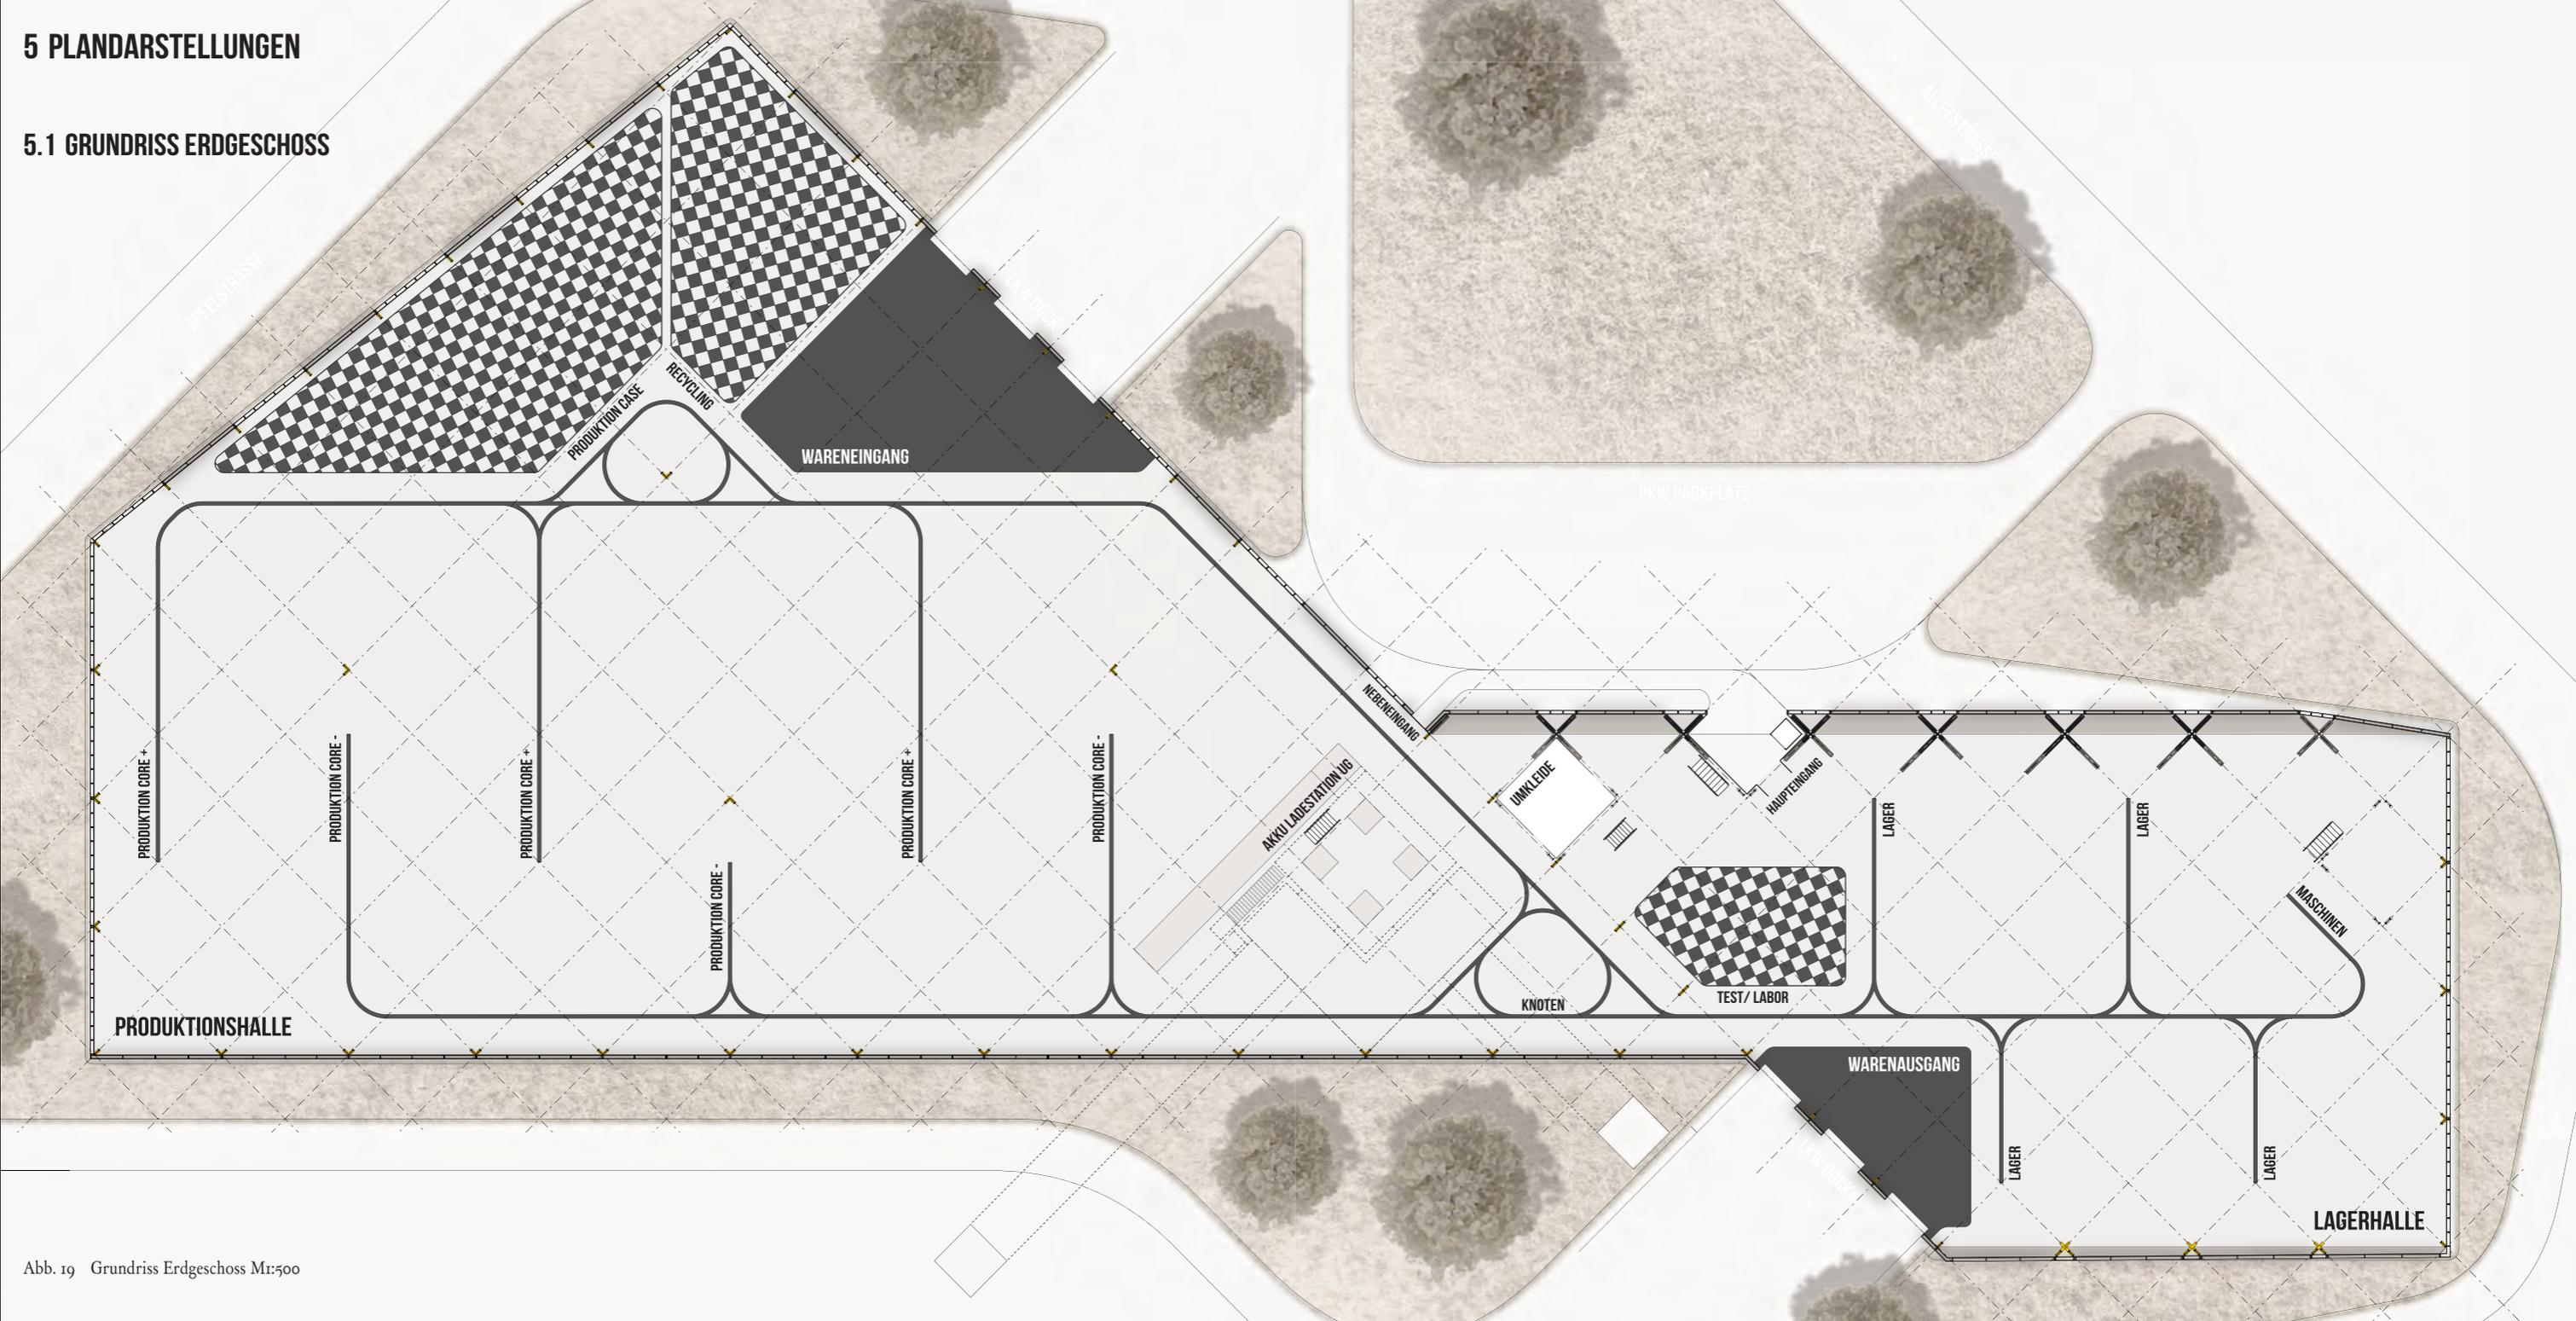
Grundriss Erdgeschoss M1:500
